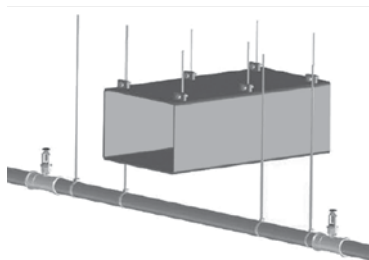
Пример размещения креплений при пересечении с другим оборудованием (воздуховод)
